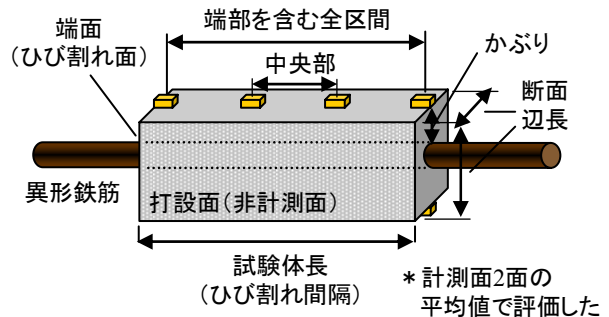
ひび割れ間コンクリート模擬供試体の概略
